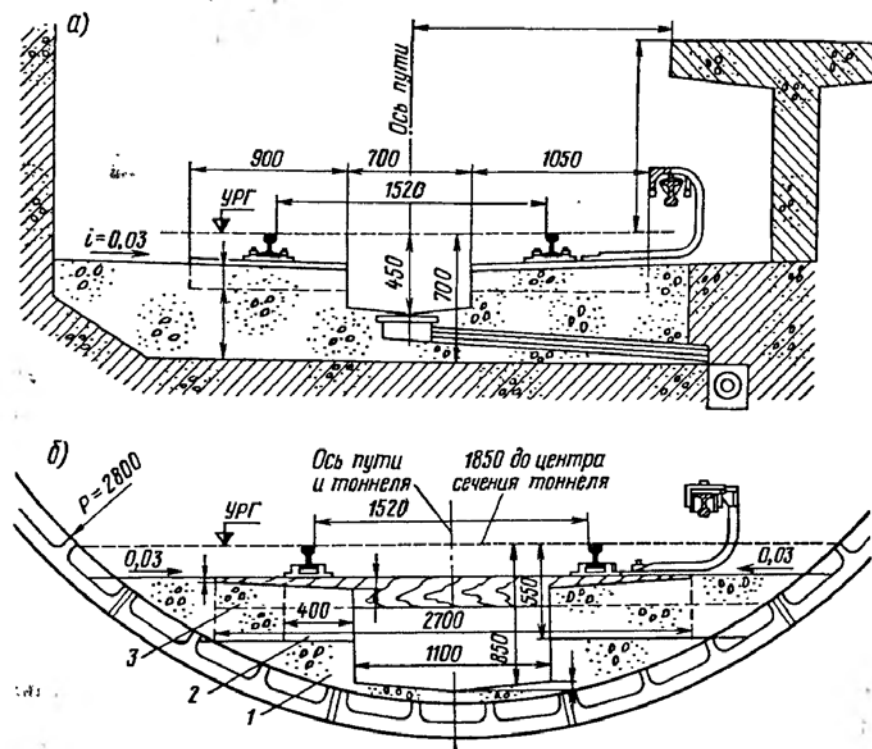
Поперечный разрез пути метрополитена: а — на станции; б — на перегоне; 1 — основание из тощевого бетона; 2 — граница основания пути и путевого бетона; 3 — путевой бетон
